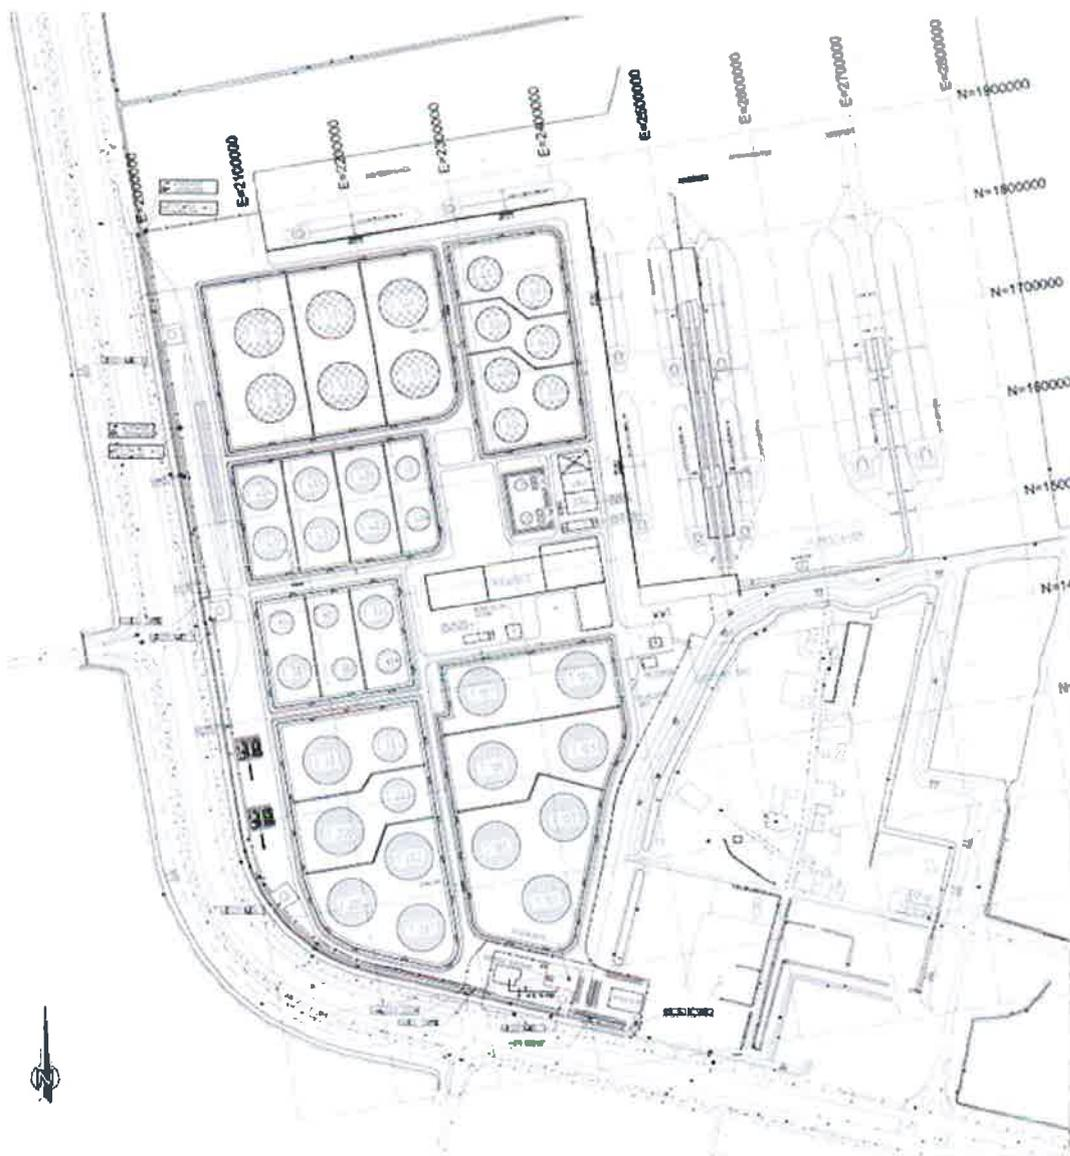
Overzichtplan geplande installaties Vopak Westpoort Terminal
